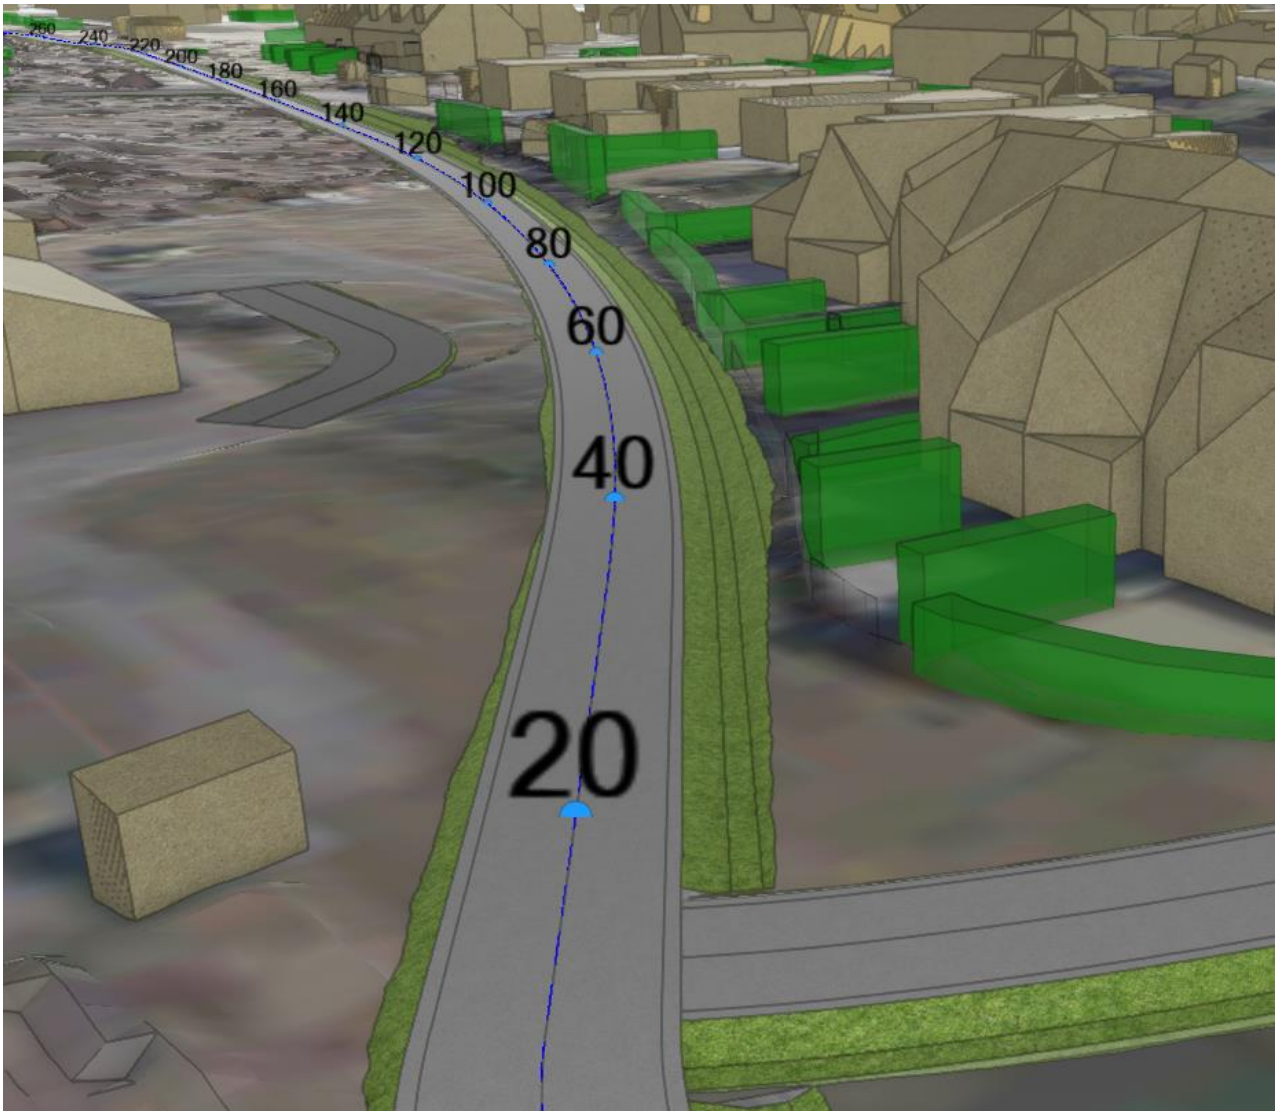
Utsnitt fra modell, modellnummer 73100. Kilde: Asplan Viak AS/VFK
